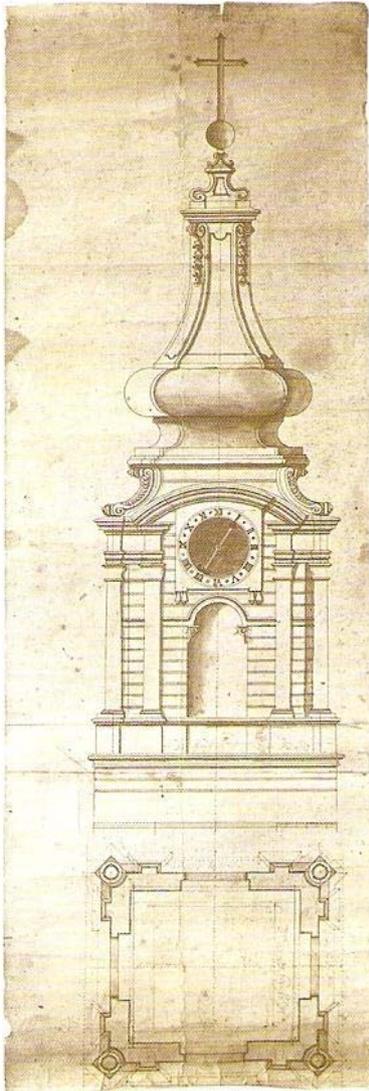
Altenburg, Stiftskirche: Auf- und Grundriss des barocken Turmhelms.
